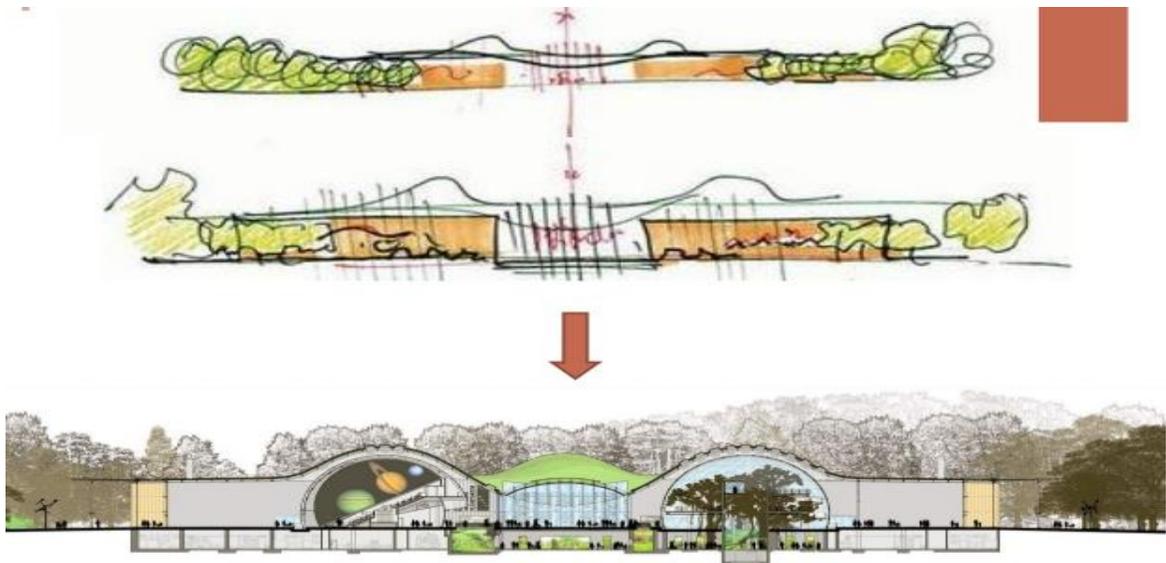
Sketch de un corte longitudinal del proyecto. Fuente: Arquitectura paisaje, 2011 Pg. 8
